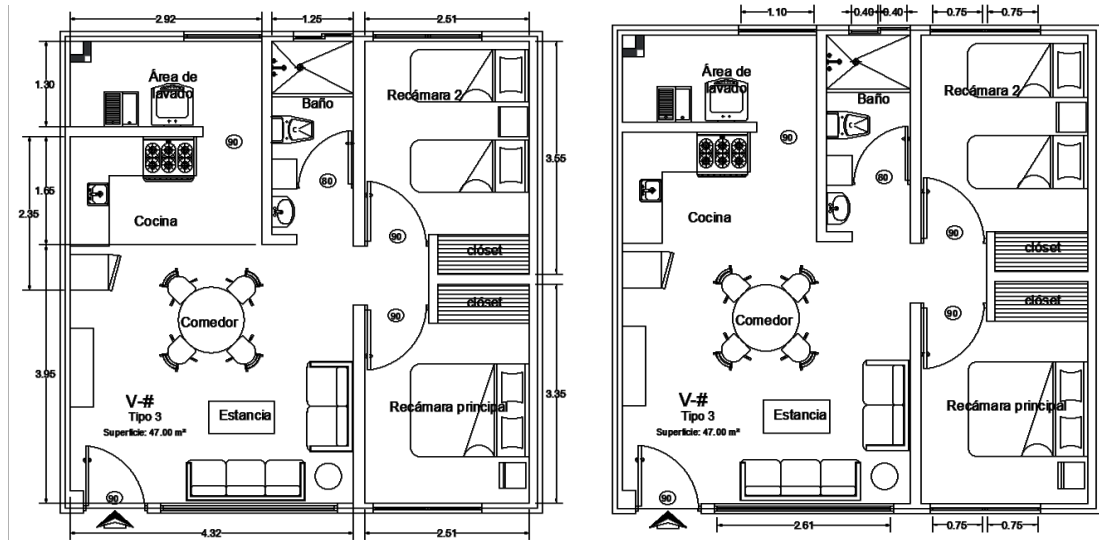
Vivienda Tipo 3 de 47m<sup>2</sup>
